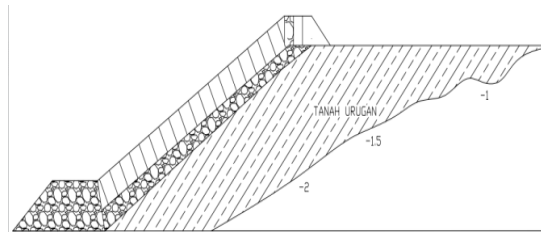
Potongan A-A Perencanaan Bangunan *Revetment
